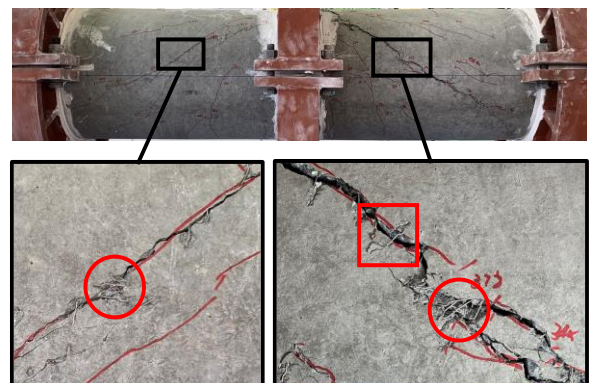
供試体のひび割れ状況（載荷終了時）
